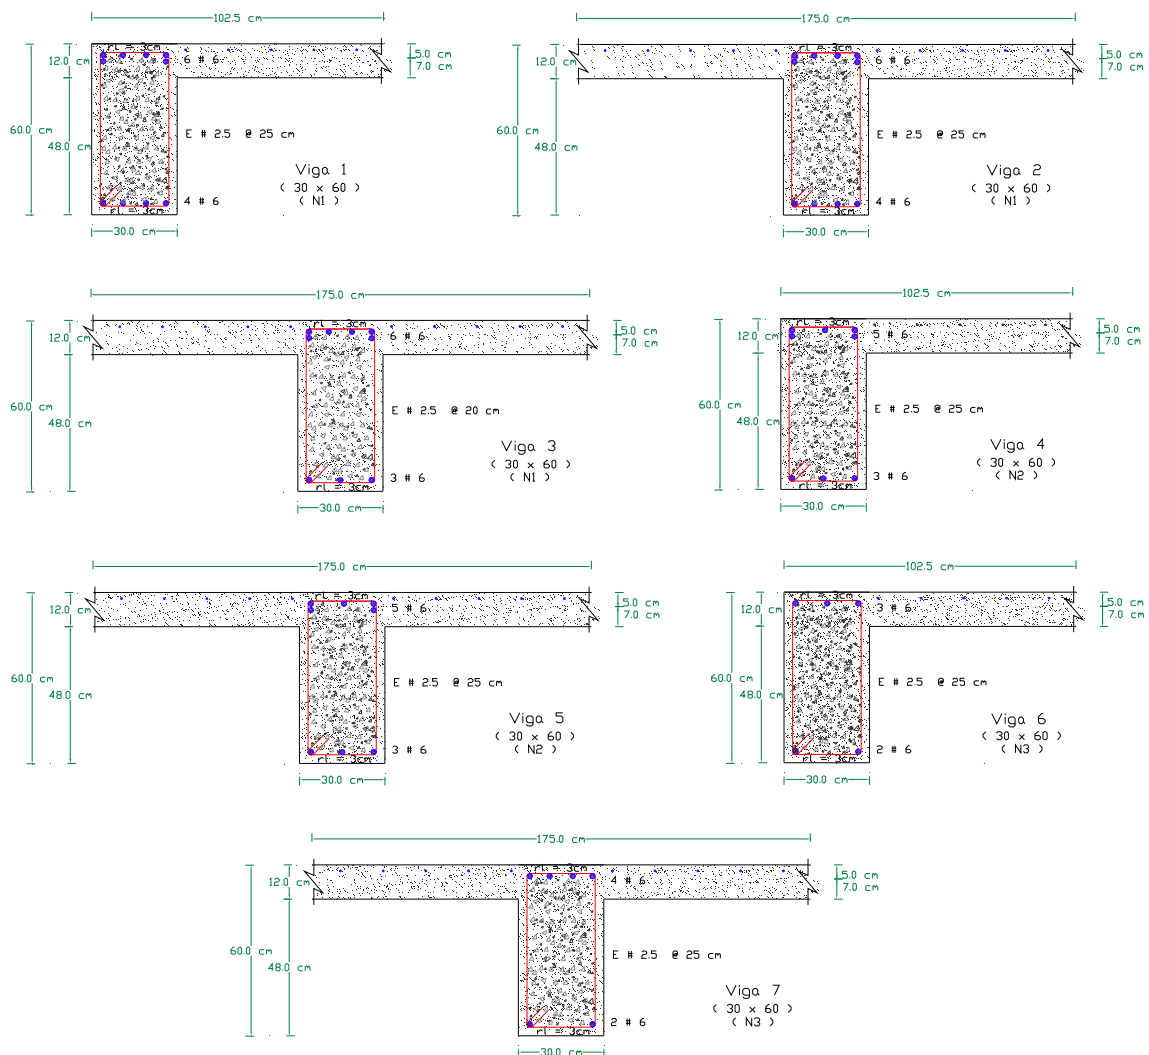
Dimensiones y armado de vigas, edificio III_3
